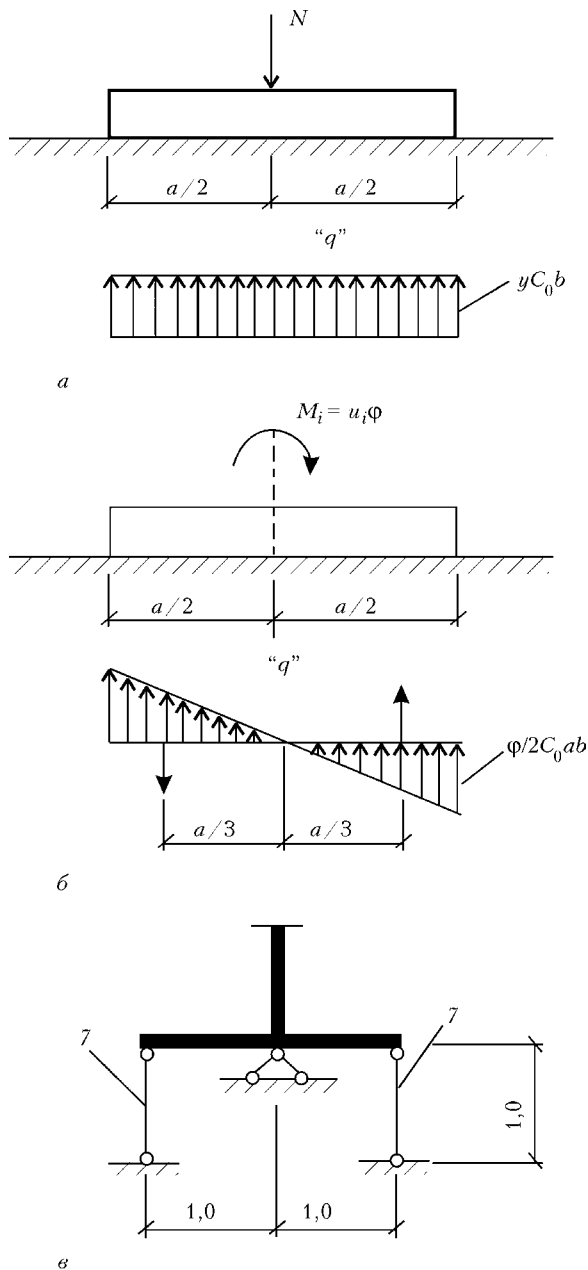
Схемы усилий при осадке фундамента (а) и при повороте фундамента (б), схематизация опорных связей на расчетной модели (в)
